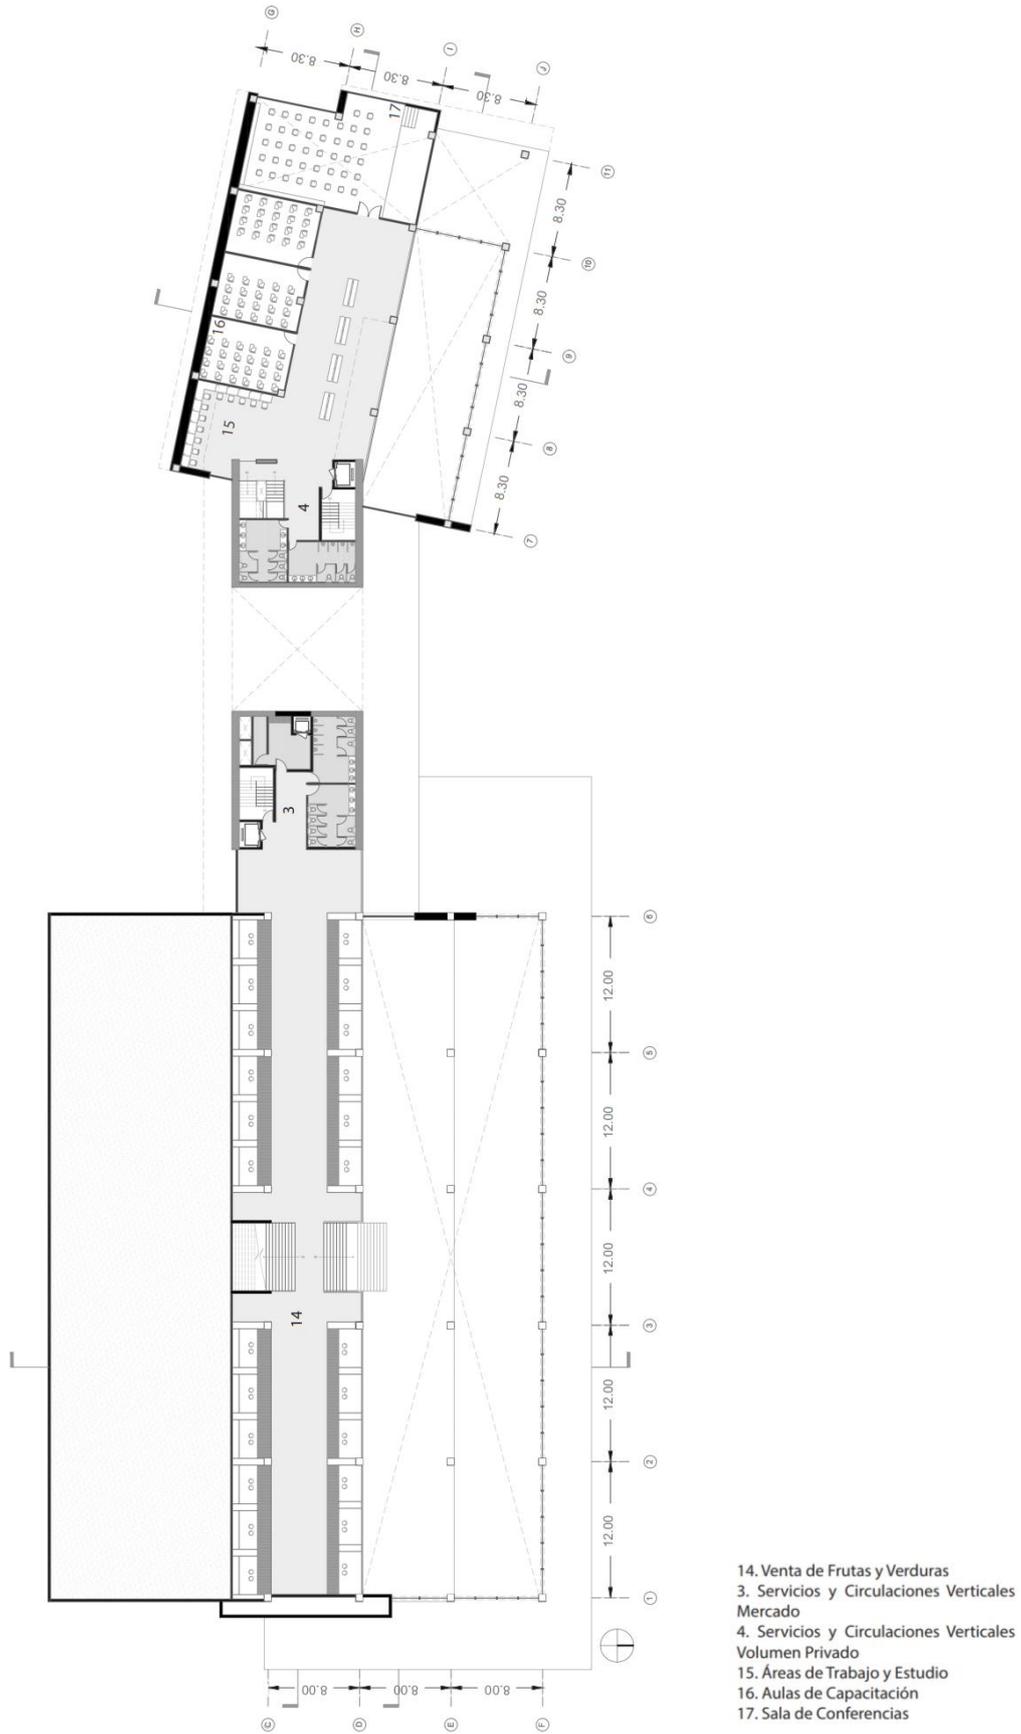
Elaboración Propia. Indicador: Planta Subsuelo Segunda N.- 6.60m.
